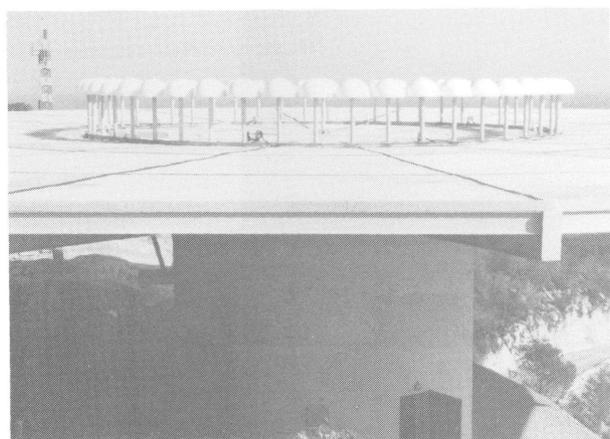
Losa de hormigón terminada y aparatos de control de navegación
